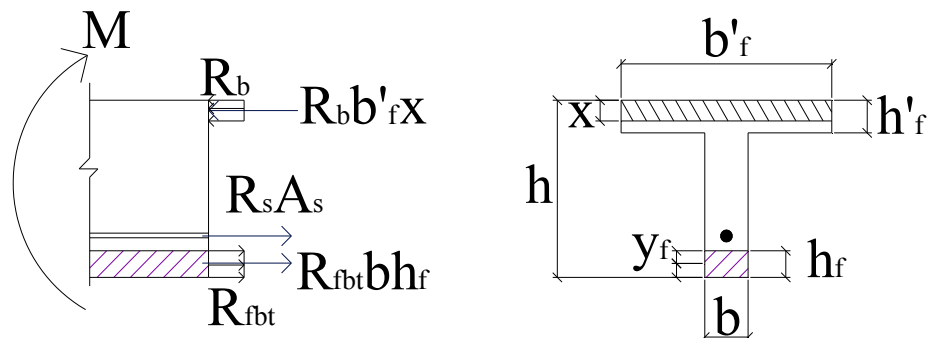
Схема усилий и эпюра напряжений в нормальном сечении изгибаемого железобетонного элемента, усиленного наращиванием фибробетоном снизу
